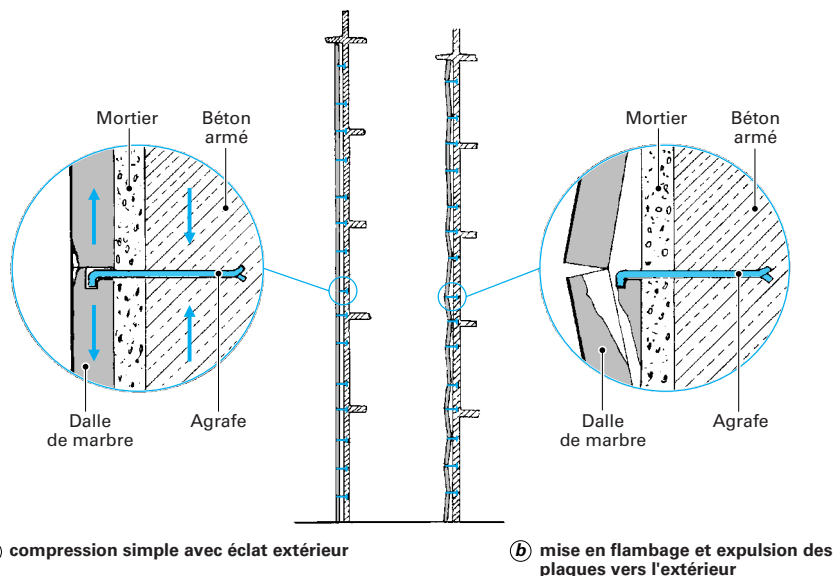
Mise en compression du revêtement en pierre par contraction du béton
